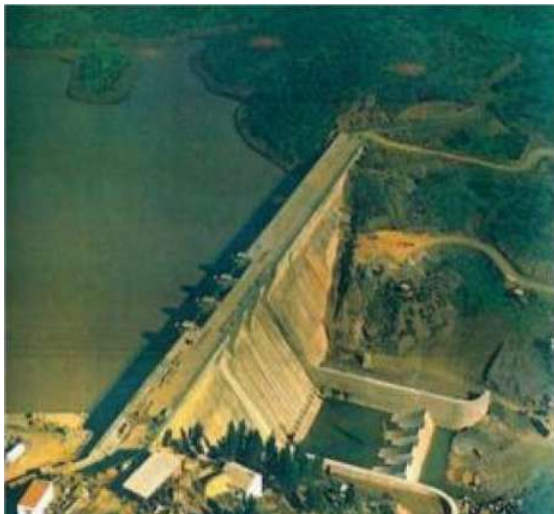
Presa de gravedad Fuente (Vallejo)
